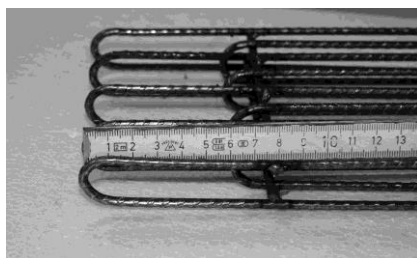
Stabstahlbewehrung im Fugenbe-
